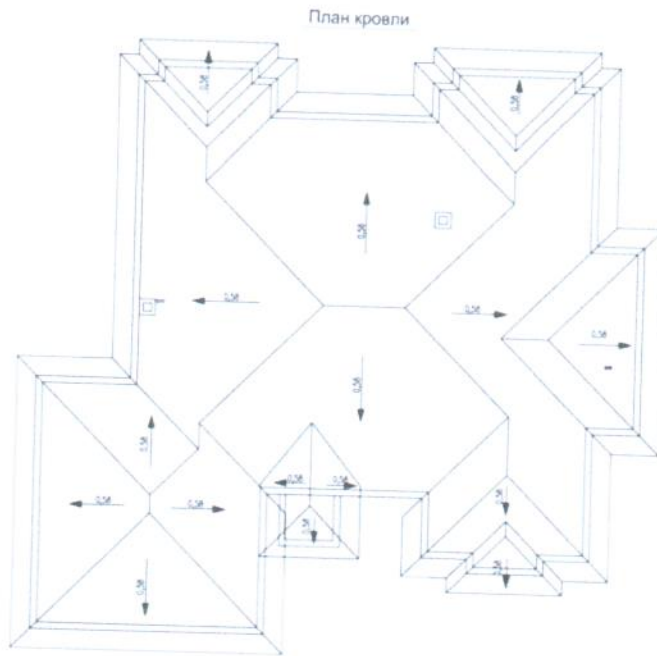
Пример изображения плана шатровой крыши малоэтажного жилого здания.
